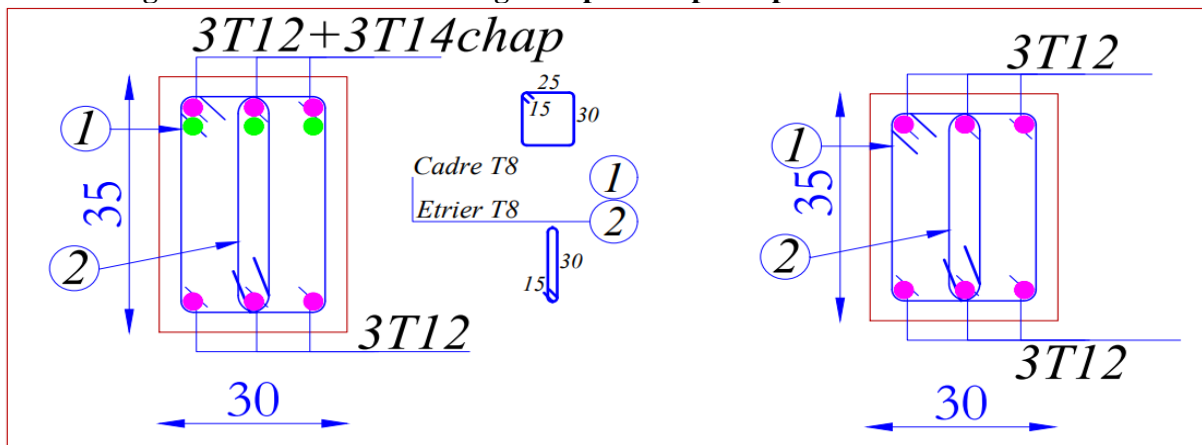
schéma de ferraillage des poutres secondaires associées au voile.
